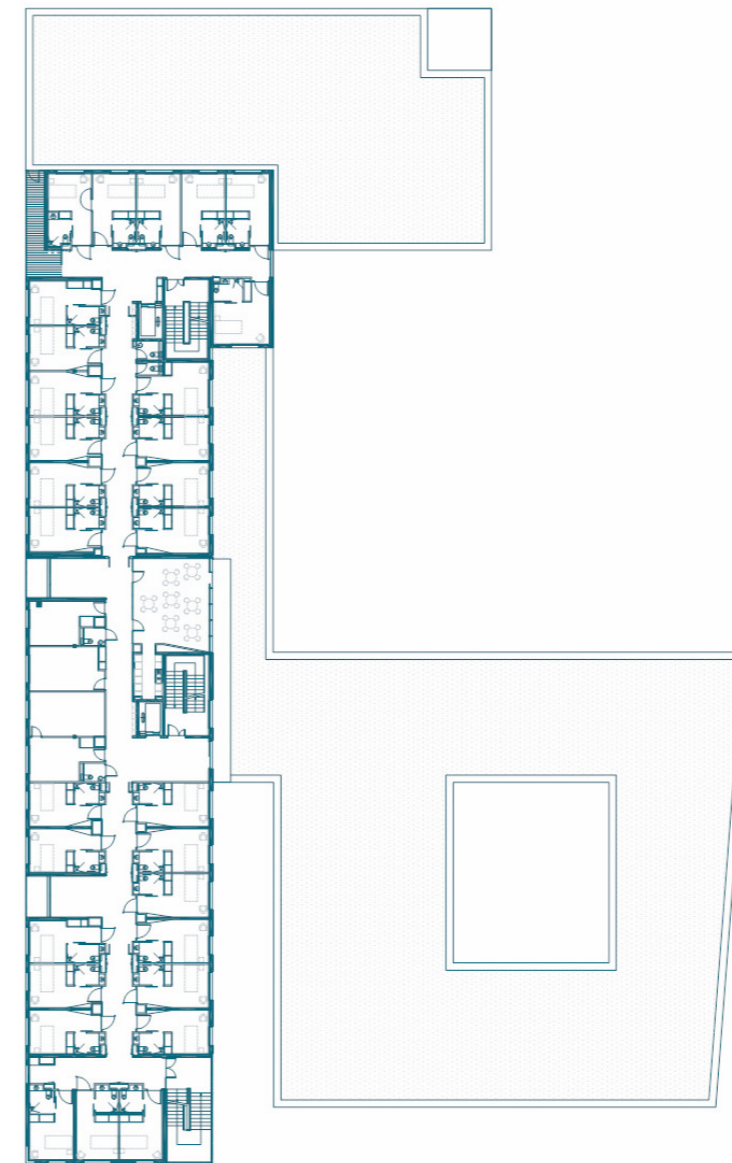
Pianta del piano primo (© Stéphane Chalmeau)
